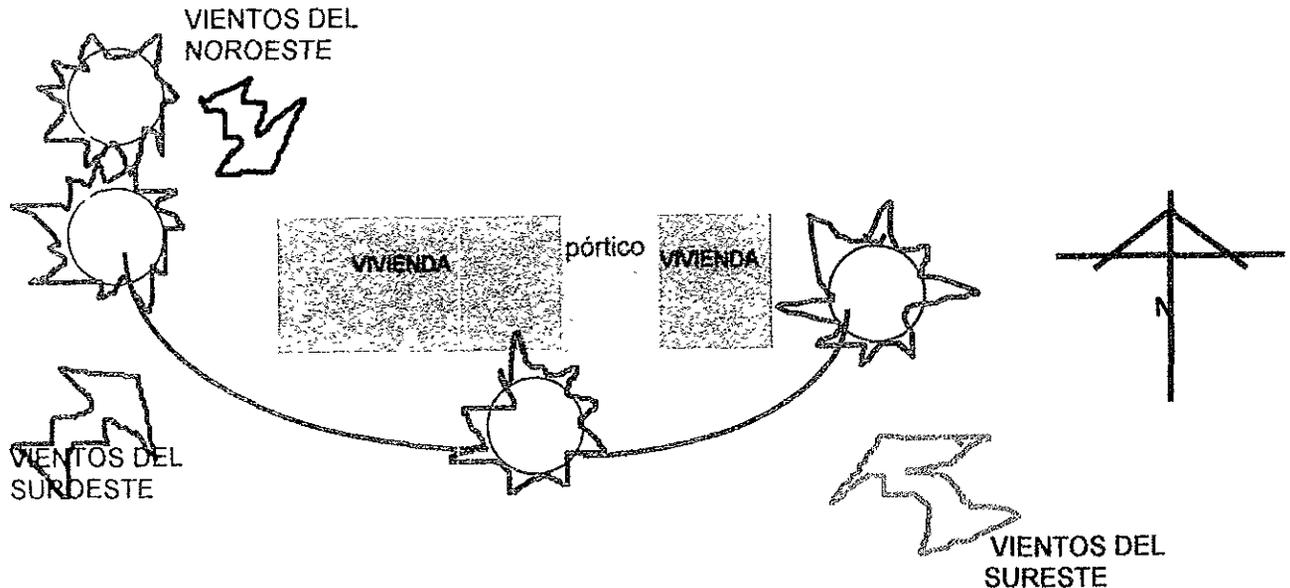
Utilización del pórtico Tipo 3 en orientaciones Este y Oeste de las viviendas muestra.
